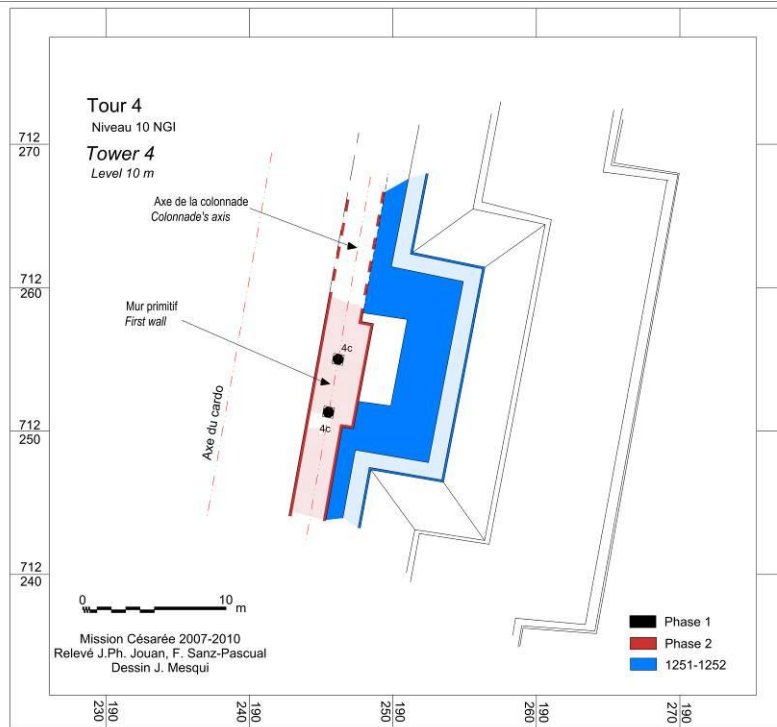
Plan de la tour T4 au niveau 10 m ASL
